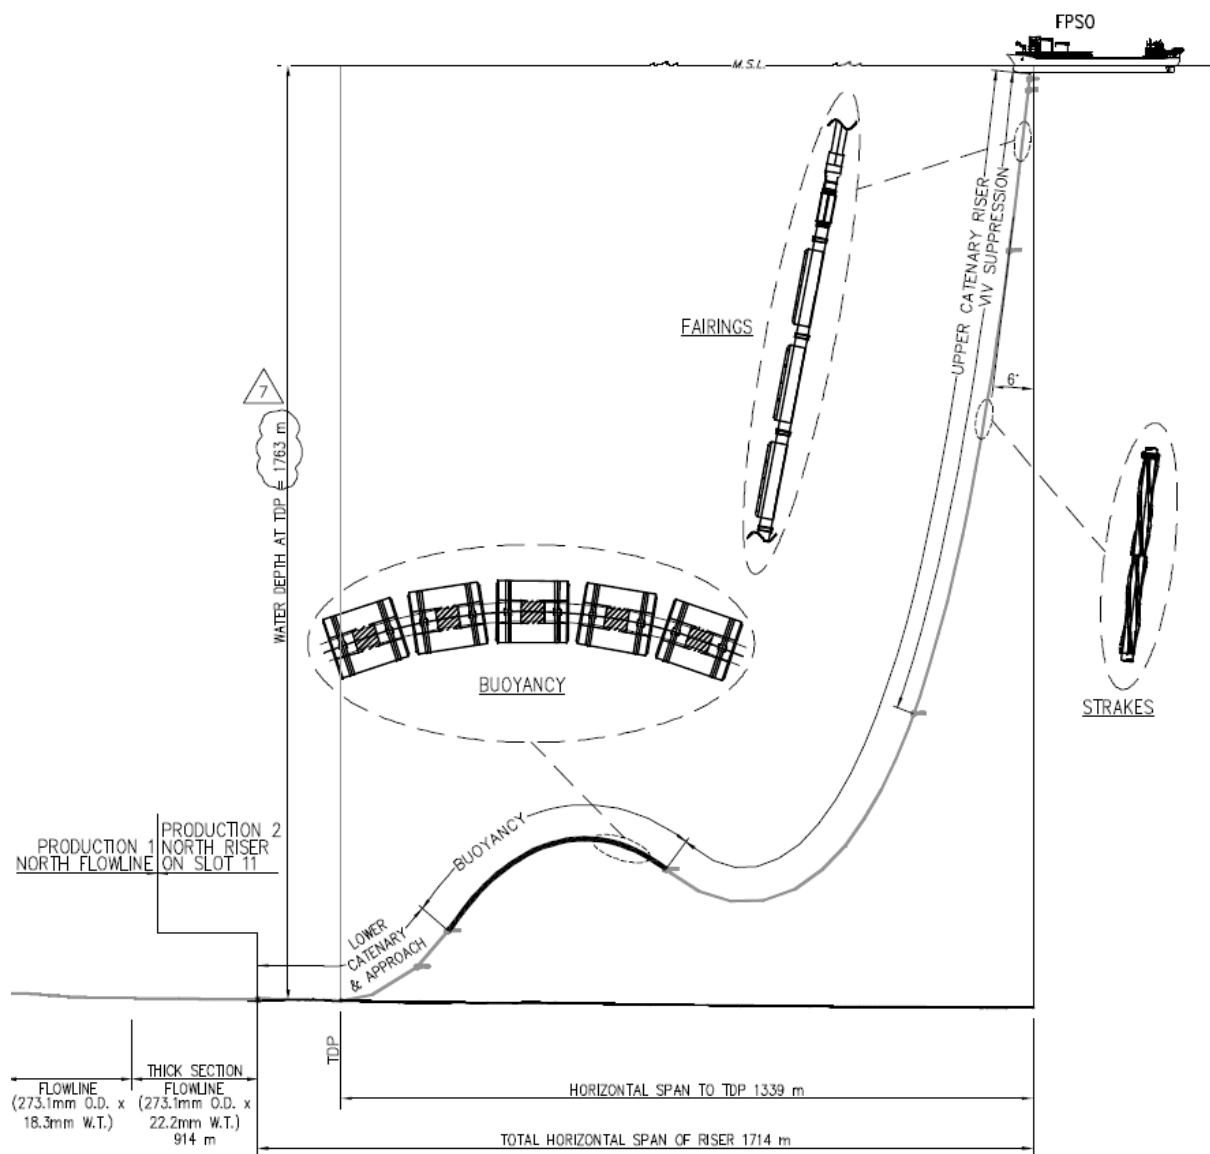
Arranjo típico de riser instalado em BC-10
